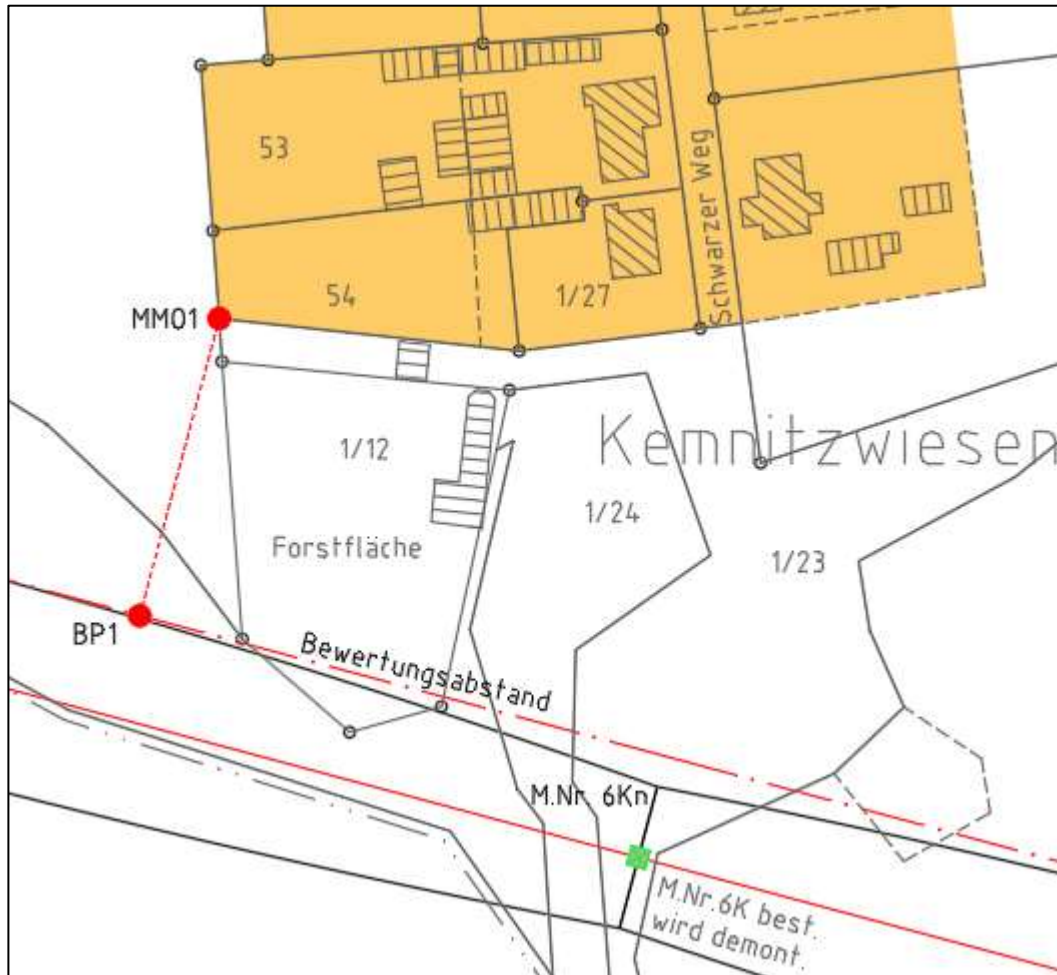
Lageplanausschnitt mit dem Minimierungsort 1
